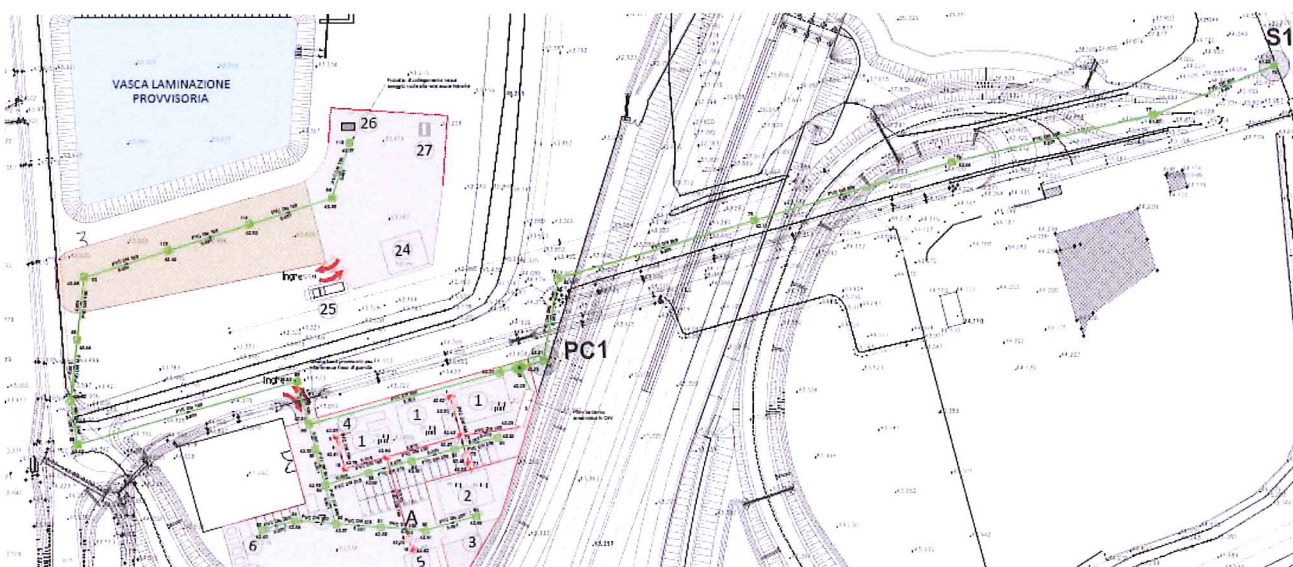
Lay-out delle reti fognarie a servizio dell'area logistica di cantiere – lato Sud.
